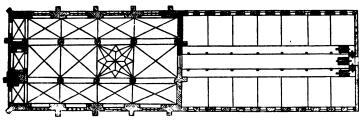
Heiligengeist-Kirche. Grundriss. 1:667.
